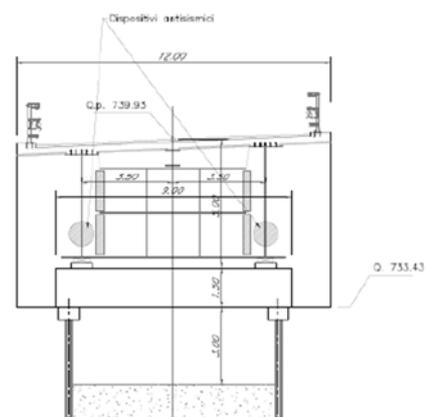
Sezione longitudinale e trasversale della Spalla A – Lato Cosenza – Dettaglio su Dispositivo sismico
